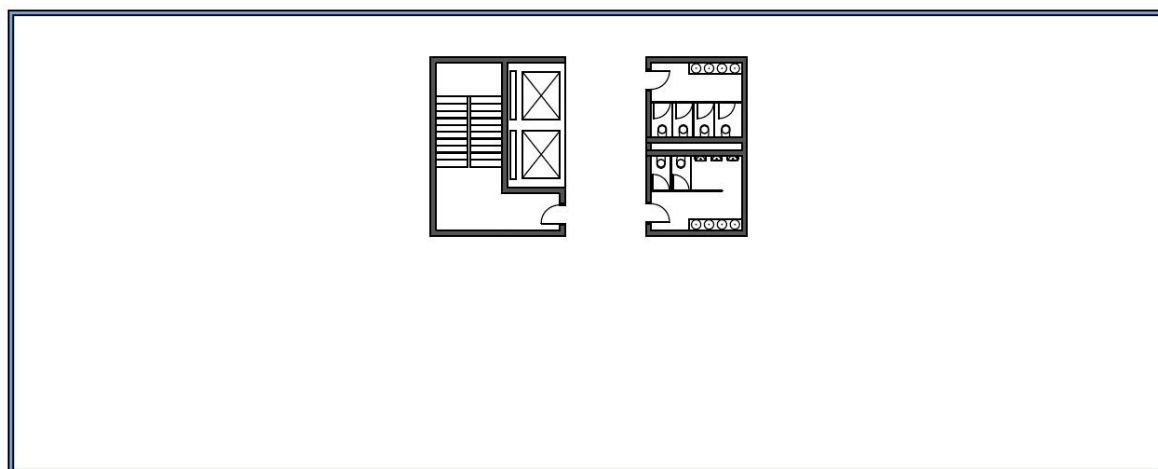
Planta do 2º, 3º, 4º, 5º e 6º piso
